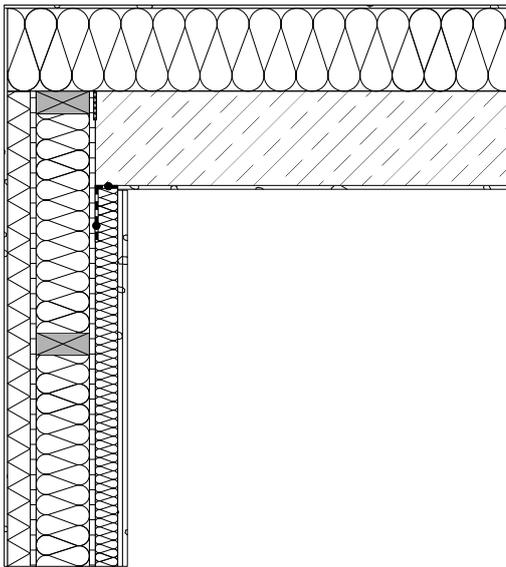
Eckstoß Außenwand WA1-3 - Außenwand WA4
